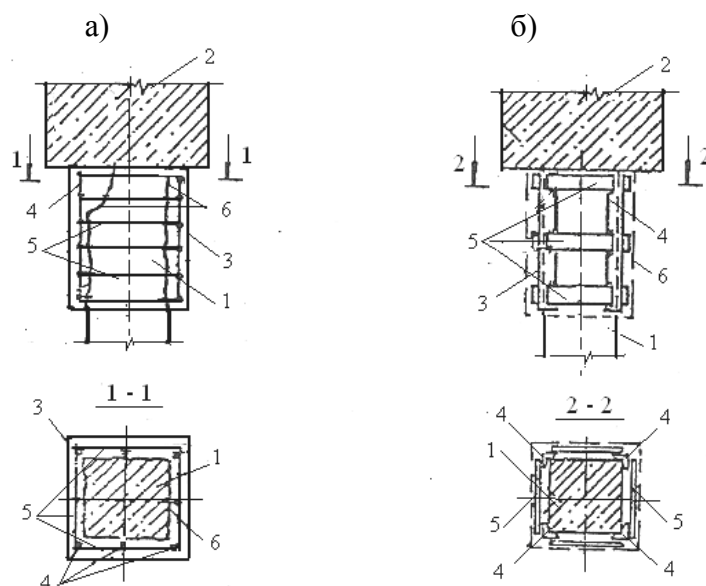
Усиление узлов сопряжения свай устройством железобетонной (а) и металлической обойм (б):
